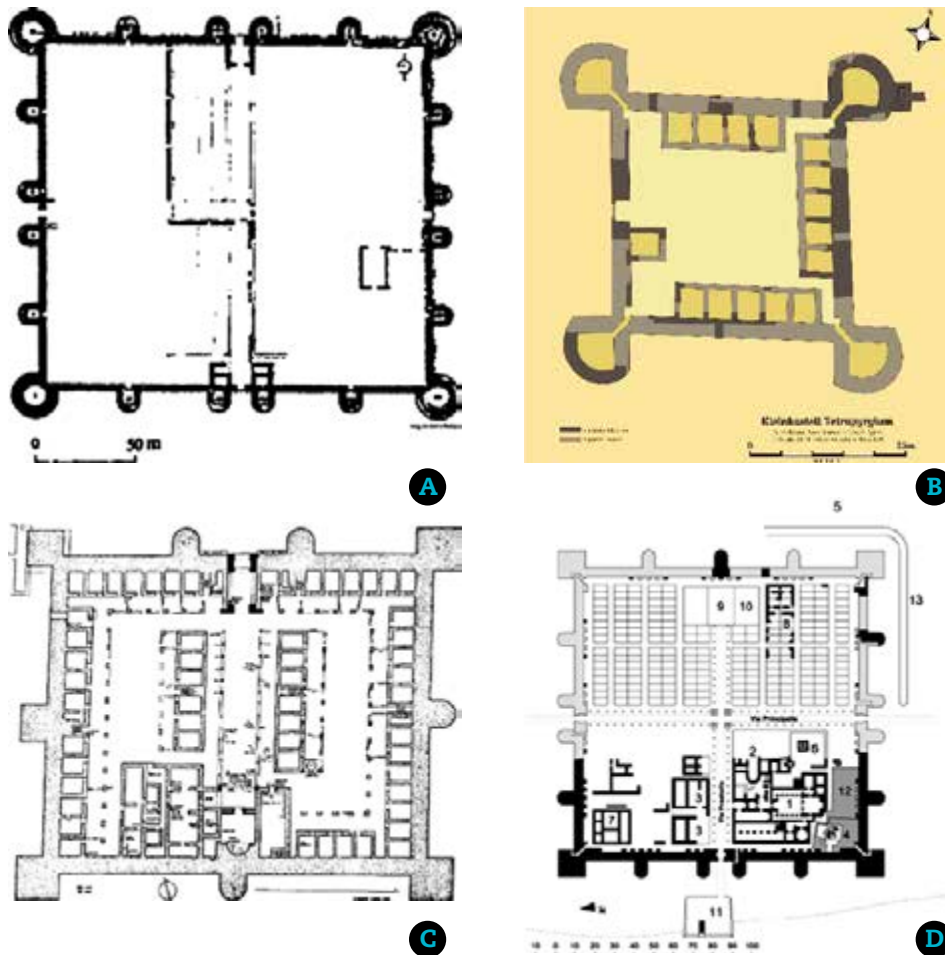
A. Planta del campamento de Dumayr, según Brünnow-Domaszewski. Escala aproximada 1/2,000. (citado en Lenoir 1999); B. Planta de Tetrapyrgium/Qusair al-Saila; C. Planta de Qasr Qarun/Dionisio (Según Schwartz 1969); D. Plan esquemático de Nag al-Agar (Según Karelin 2011).
